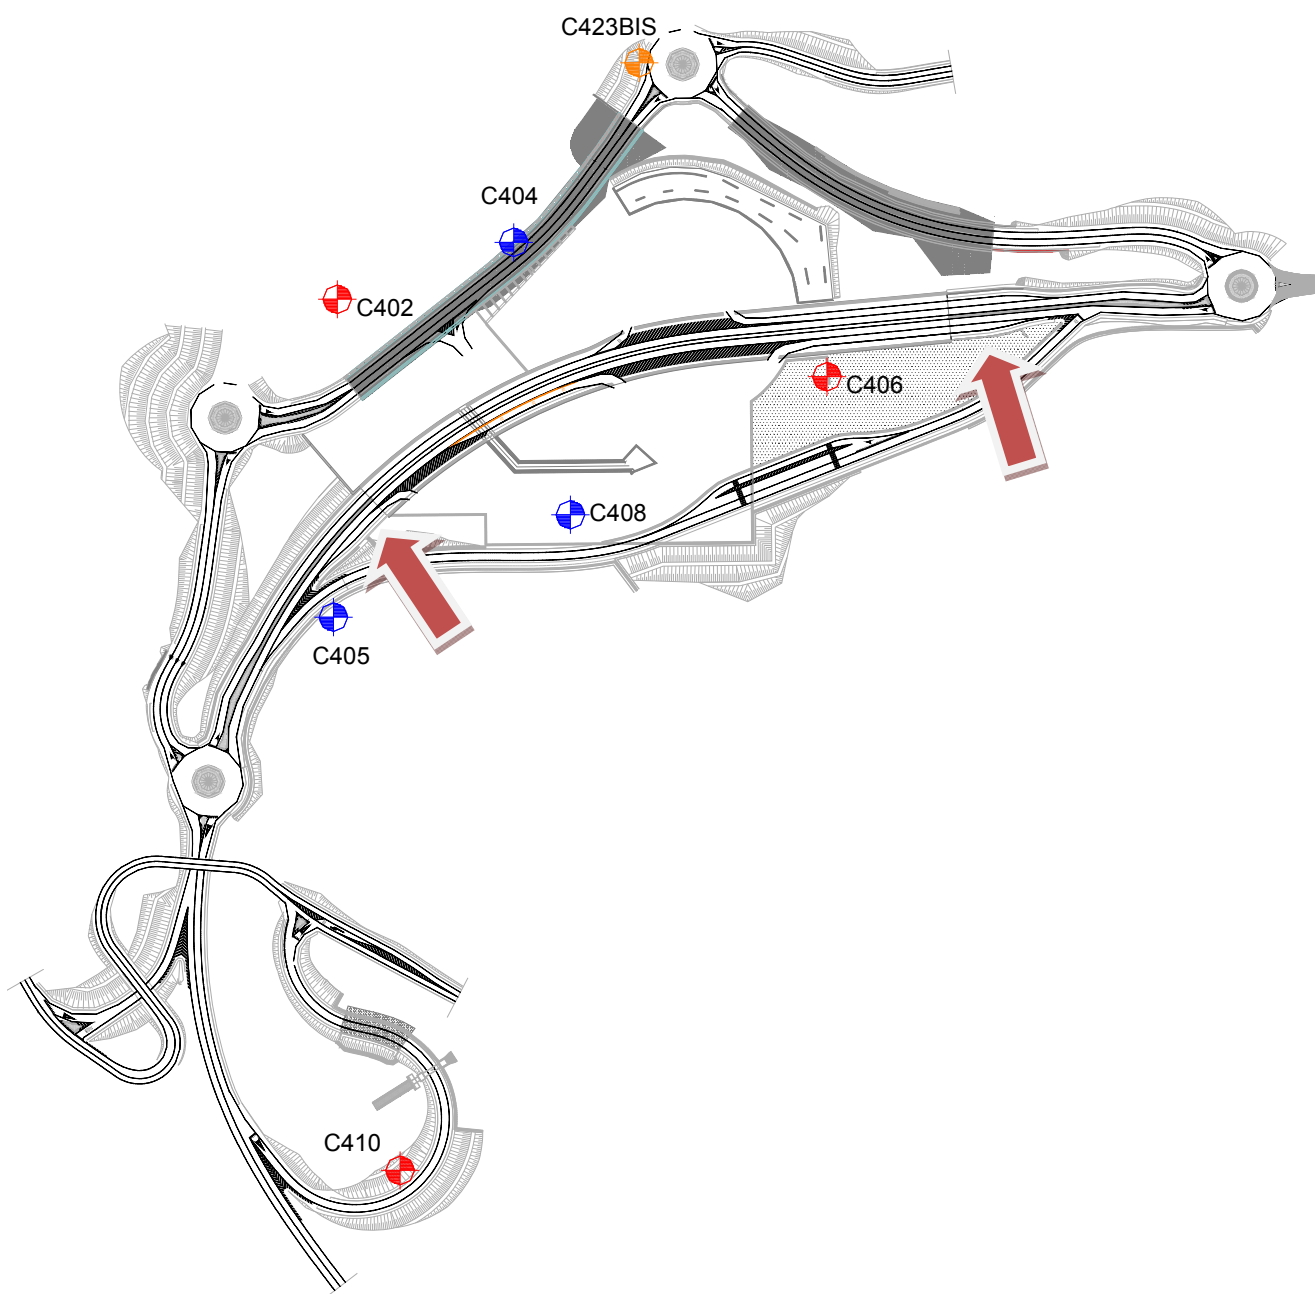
a – Stralcio planimetrico con ubicazione delle opere e dei sondaggi
